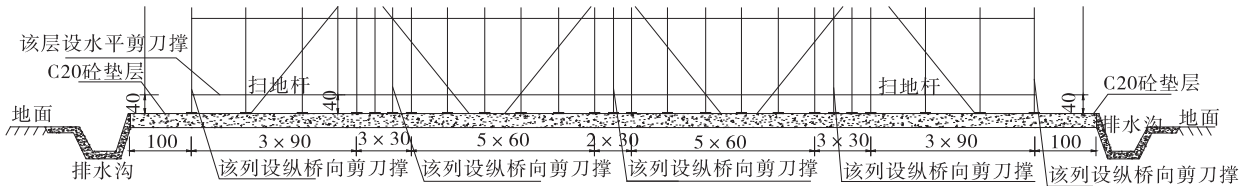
某膨胀土地基现浇桥支架和排水布置横断面(单位:cm)
